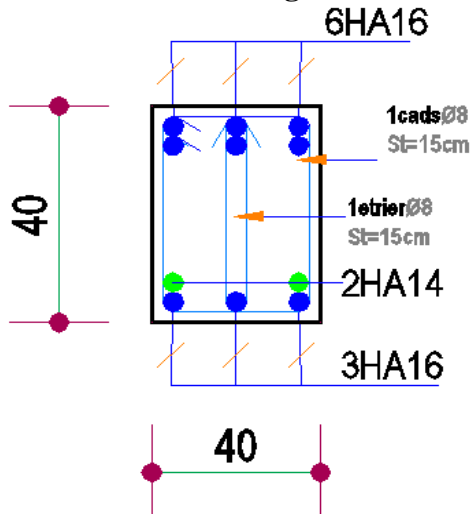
Schéma de ferrailage De la poutre brisée en appui
